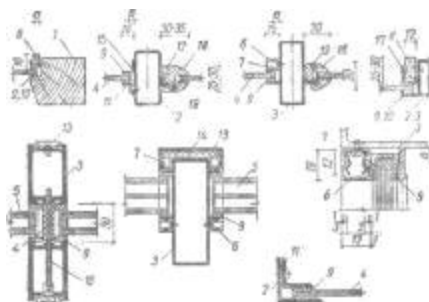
Крепление стекла к переплетам: 1, 2, 3 — обвязка переплета (деревянная, стальная, алюминиевая); 4 — стекло; 5 — стеклопакет; 6 — штапик; 7 — стальная пружина крепления; 8 — деревянный штапик, покрытый водоотталкивающим составом и лаком; 9 — уплотняющая и амортизационная прокладка; 10 — замазка; 11 — прижимный уголок; 12 — стальной швеллер, приваренный к переплету; 13 — декоративный профиль; 14 — утеплитель; 15 — опорный уголок, приваренный к переплету; 16 — стяжной болт; 17 — медный винт; 18 — резиновый профиль для крепления стекла; 19 — резиновый клин; а — зазор между стеклом и переплетом по расчету
